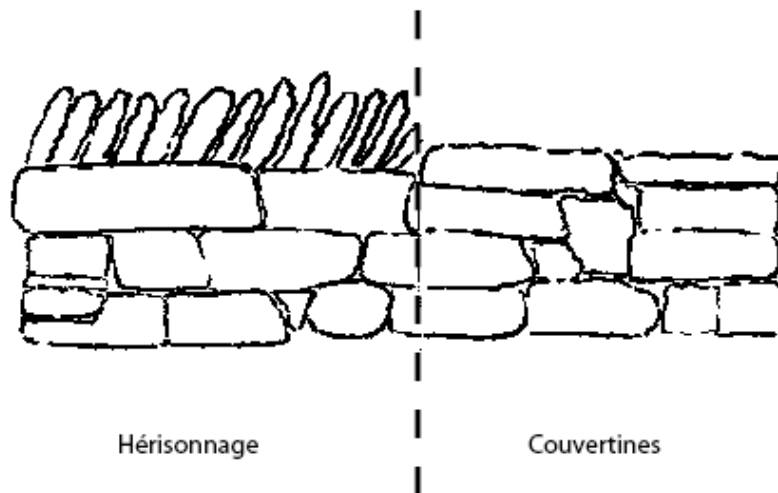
Deux murs construits différemment : hérissonnage à gauche et couvertine à droite - Août 2018
